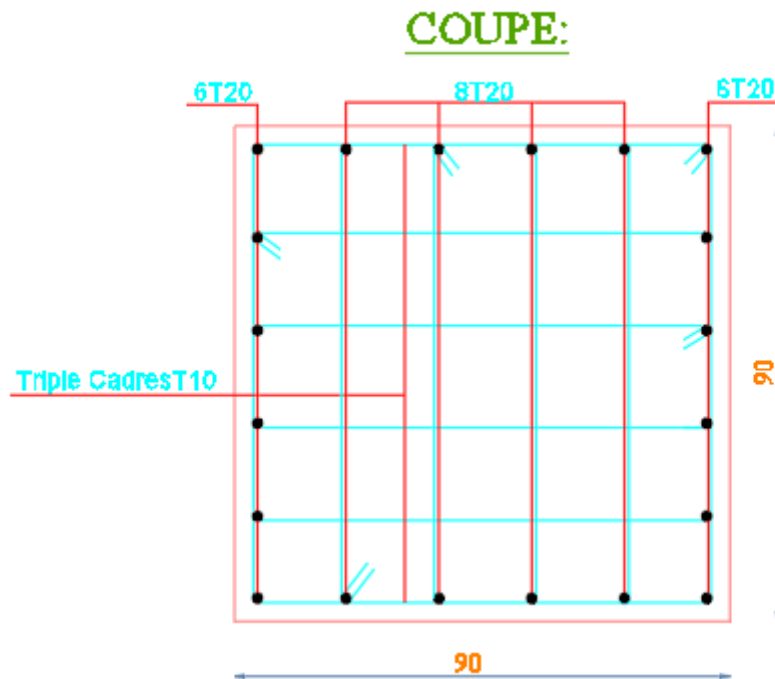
Schéma du ferrailage du poteau (90x90) cm²
